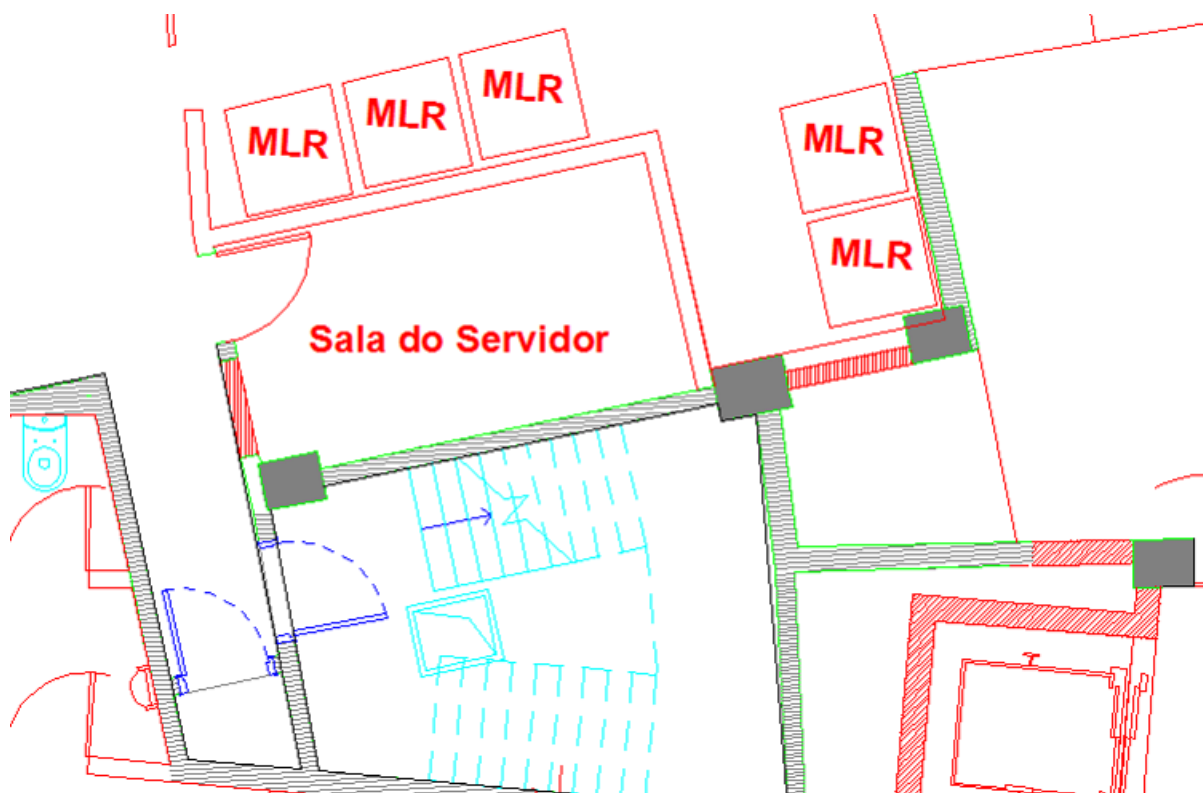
Planta do piso -1 na zona do servidor [Atelier B2, 2019]
